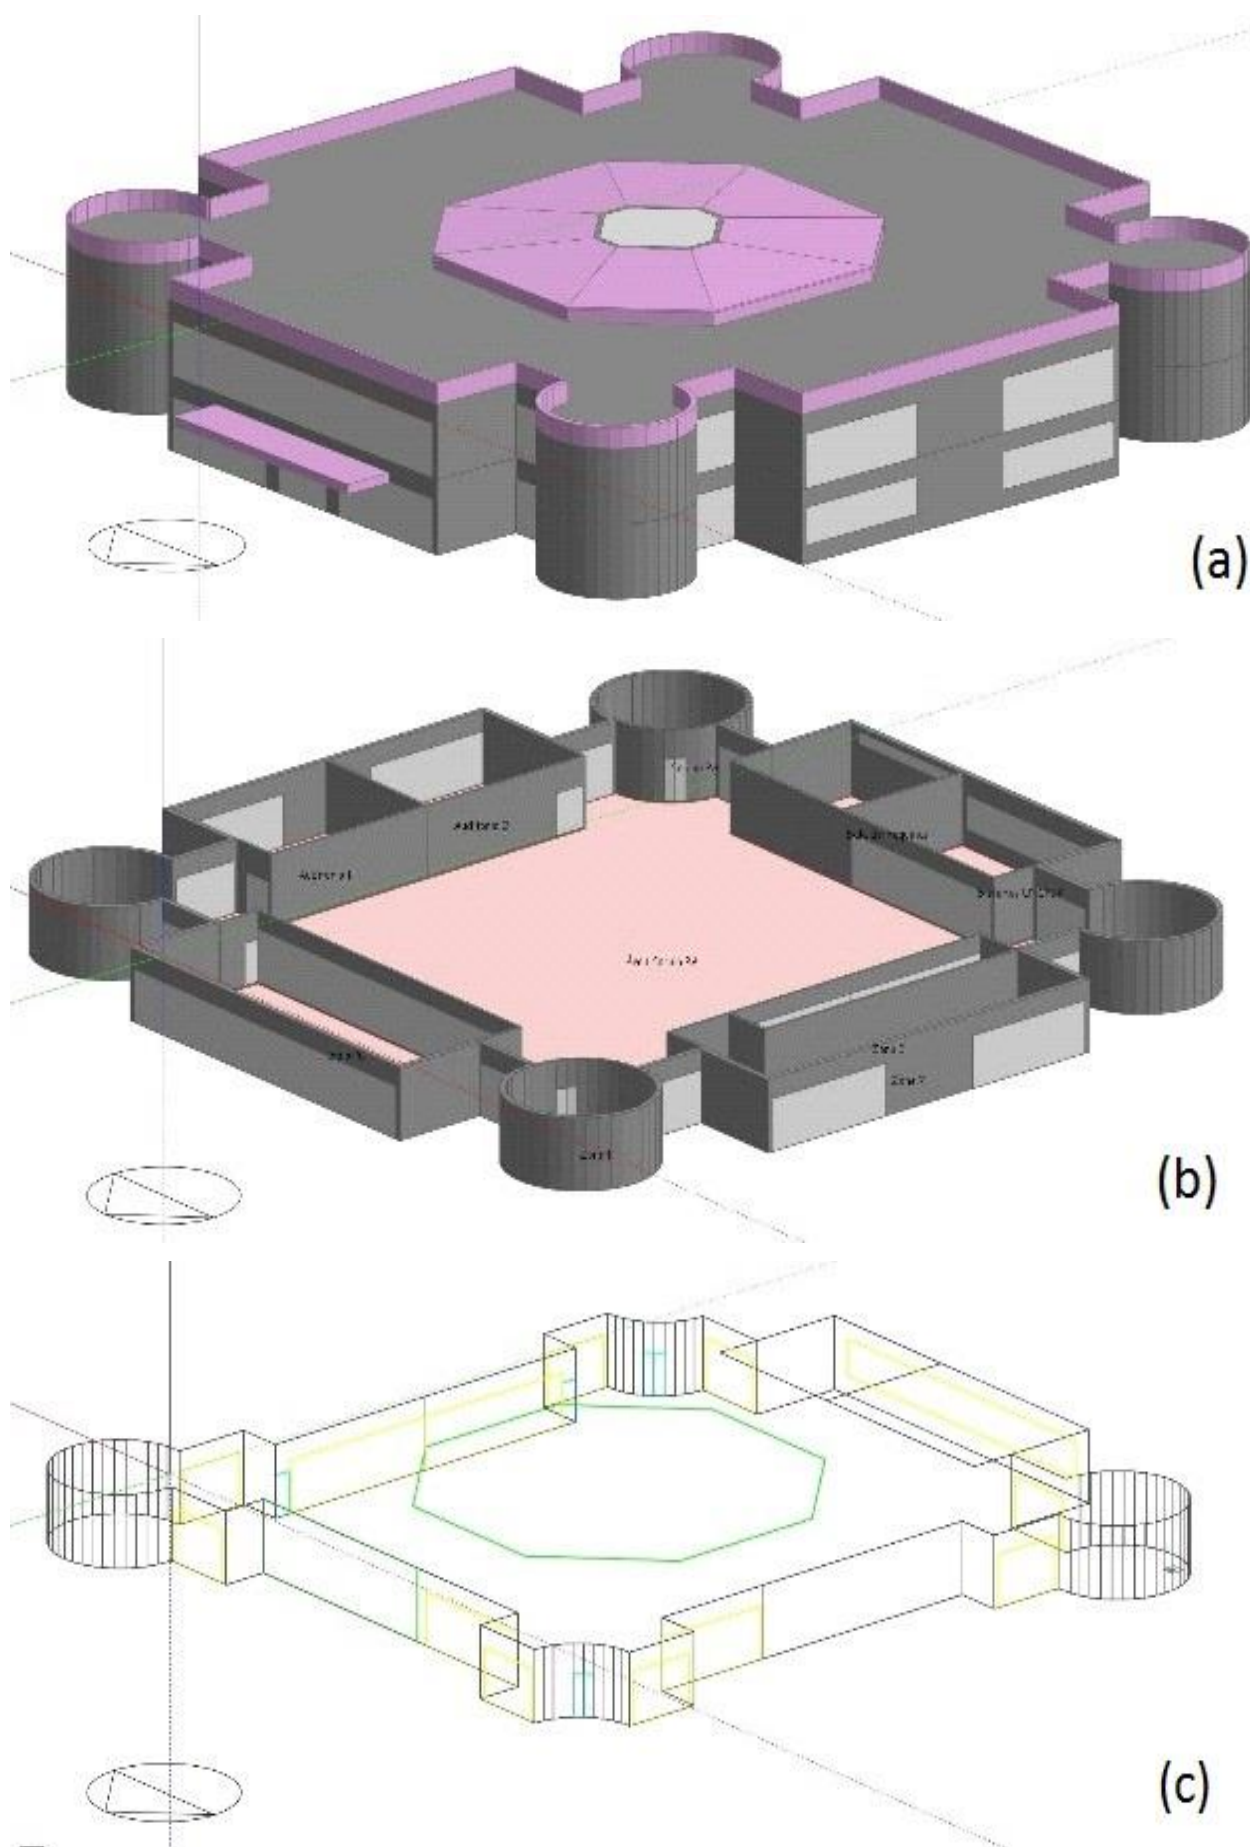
Geometría del edificio evaluado: (a) Envolvente, (b) Interior de la planta alta, (c) Interior de la planta baja.
